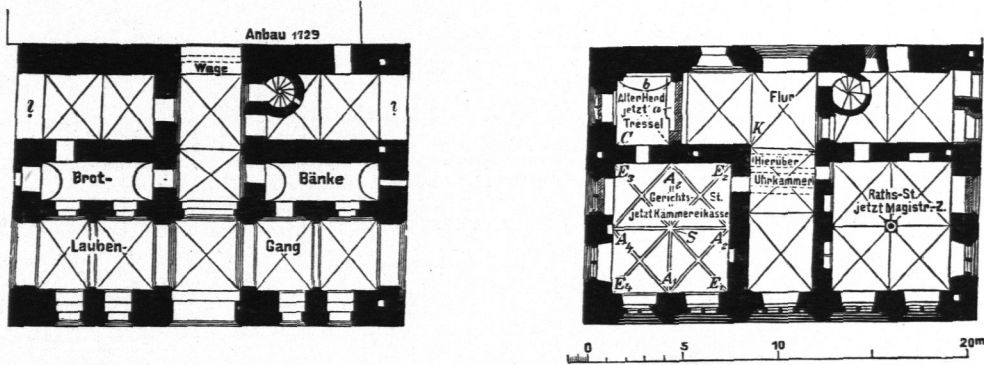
Rathaus zu Marienburg. Grundrisse vom Erdgeschoß und Obergeschoß. 1:400.
